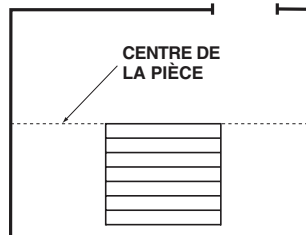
Disposition à sec pour déterminer la largeur de la planche/carreau de bordure.
